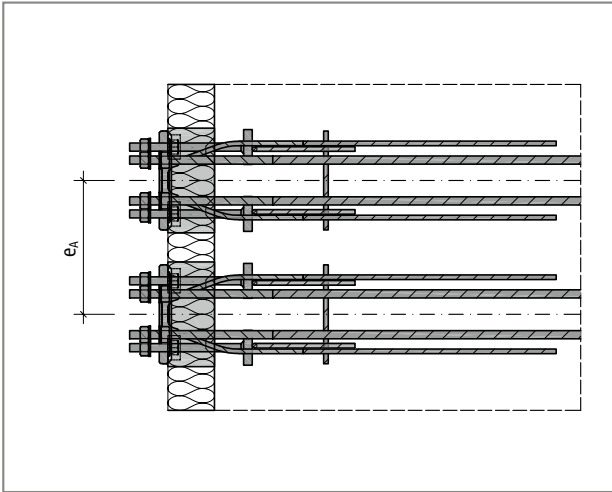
Schöck Isokorb® T type SK : Entraxe
